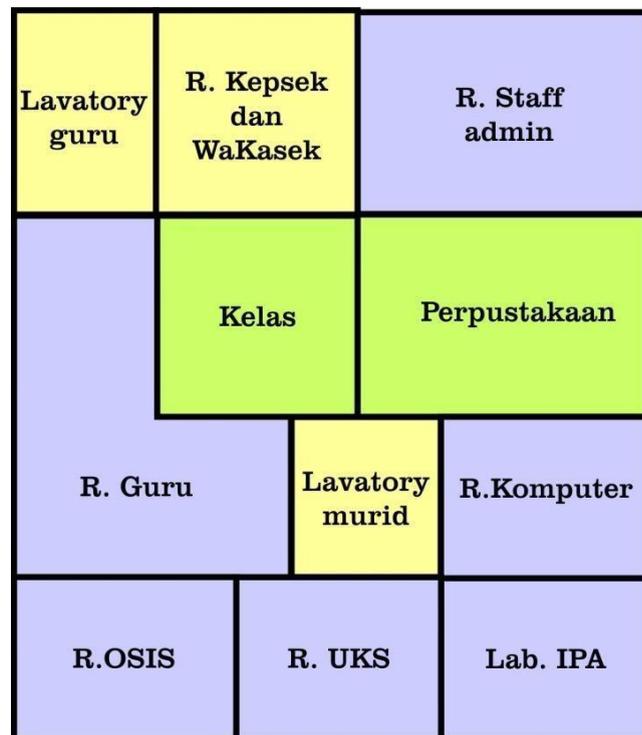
82 Block Plan Bangunan *Entrepreneur
